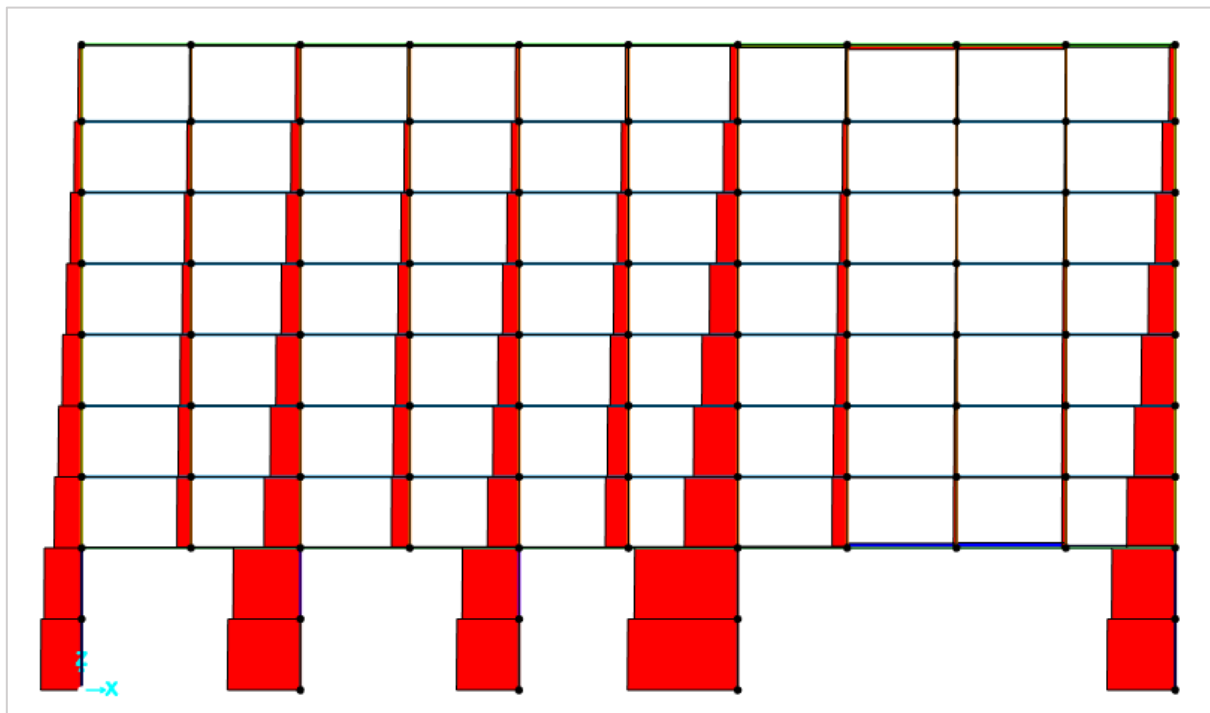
Diagramas axiles en la fachada norte del modelo sin reforzar bajo el ELA.
